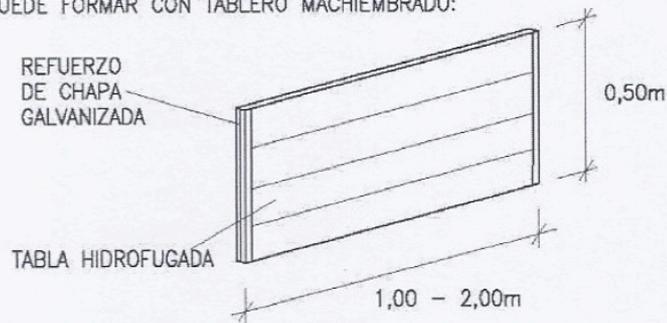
ZAPATA CORRIDA ENCOFRADA CON MADERA.
